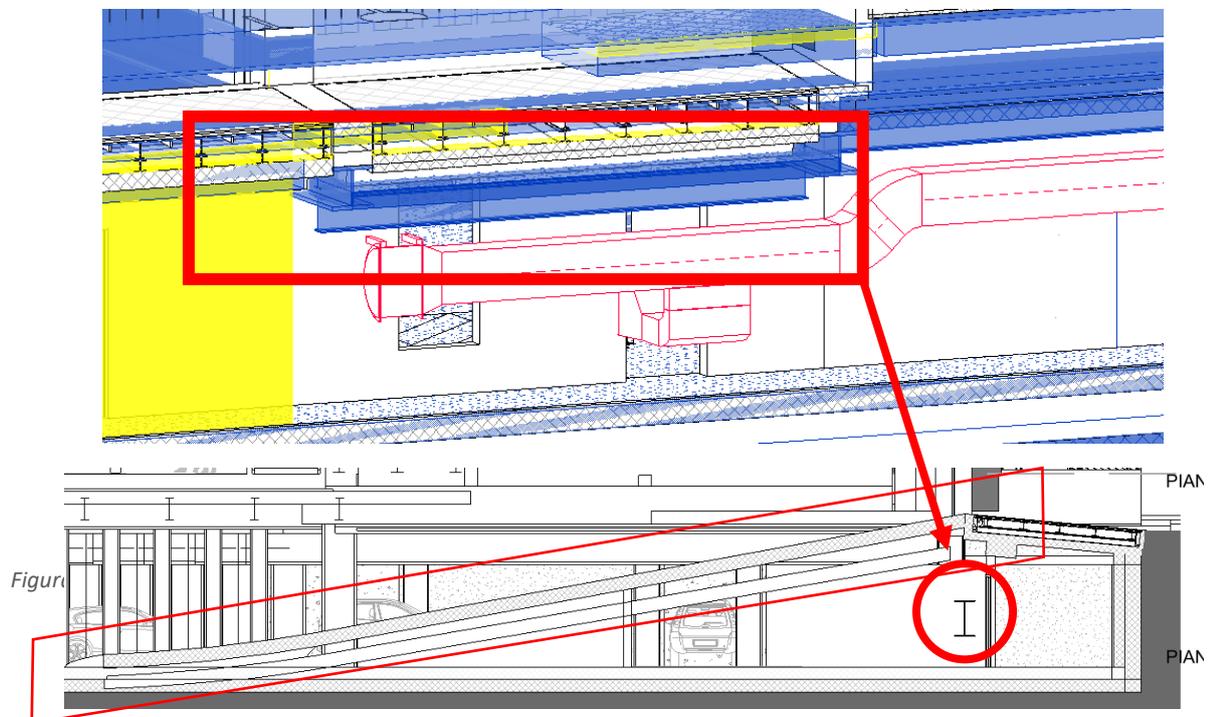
da modello problema posizionamento trave e posizionamento errato della soletta strutturale della rampa di ingresso da piazza Raggi
